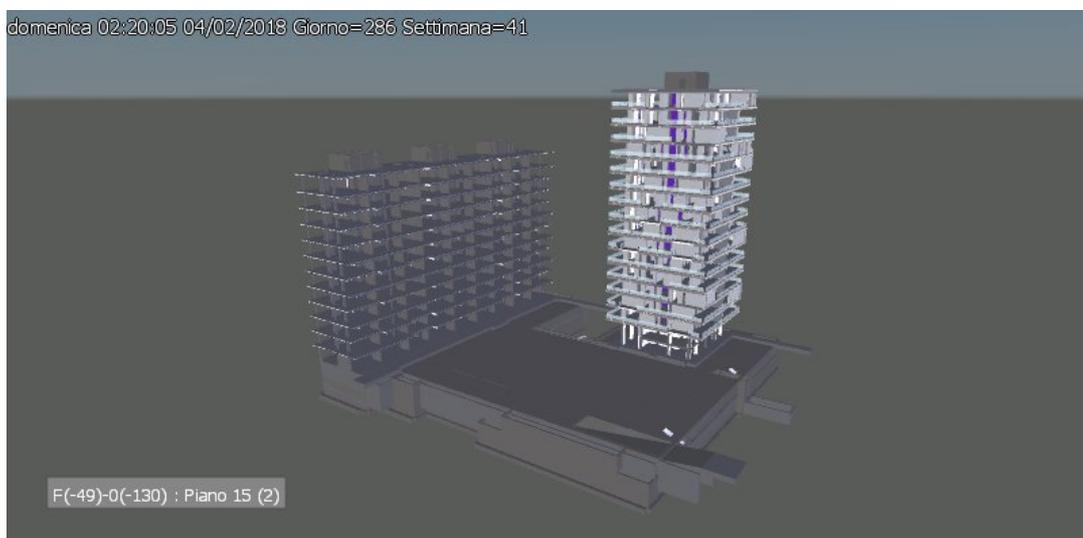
Simulazione 4D - Montaggio partizioni Tower e Montaggio porta Piastra
